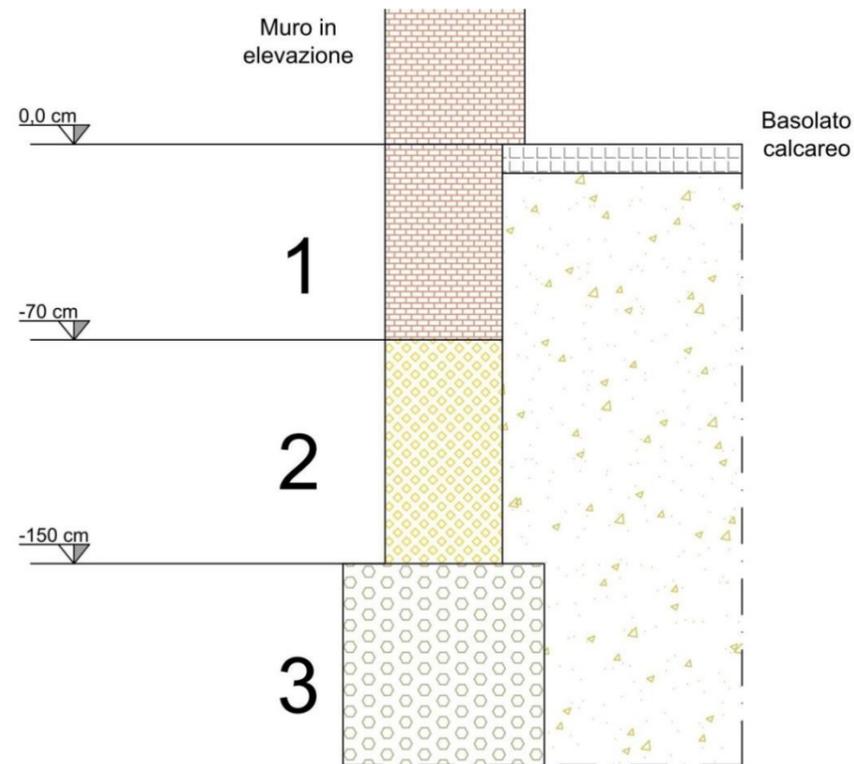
Schematizzazione strati di fondazione scala 1:20
